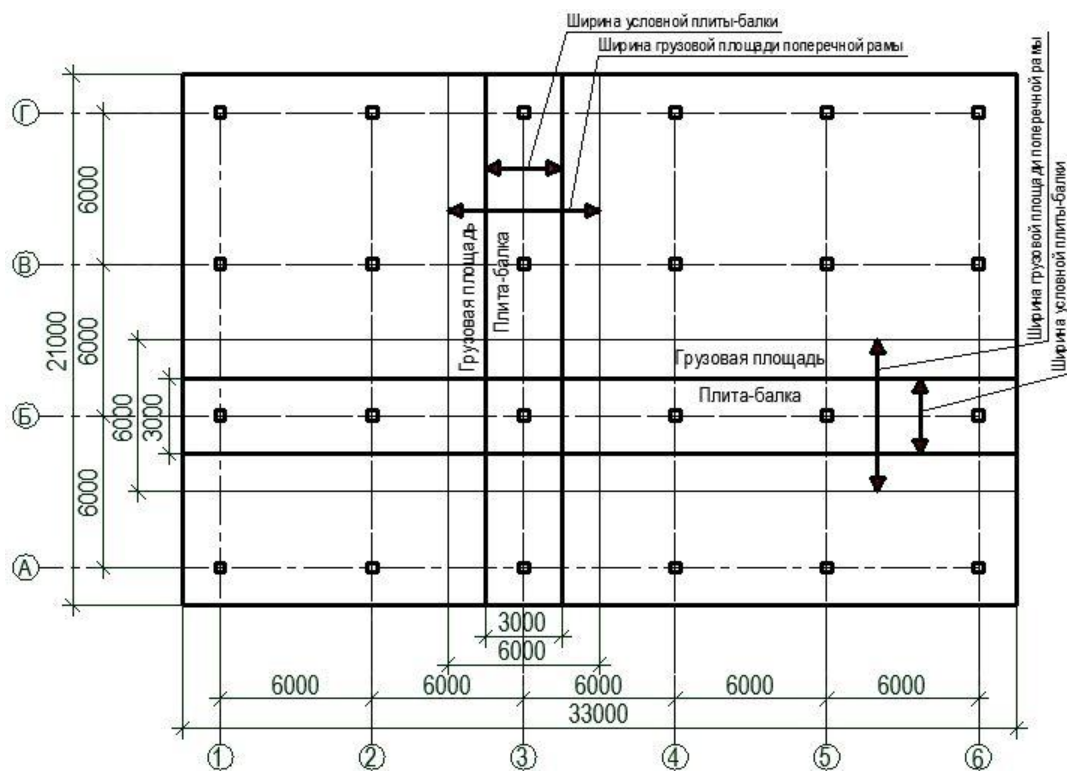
Конструктивная схема здания с безригельным каркасом из монолитного железобетона с указанием поперечных и продольных рам и грузовые площади для сетки колонн 6х6 м.
